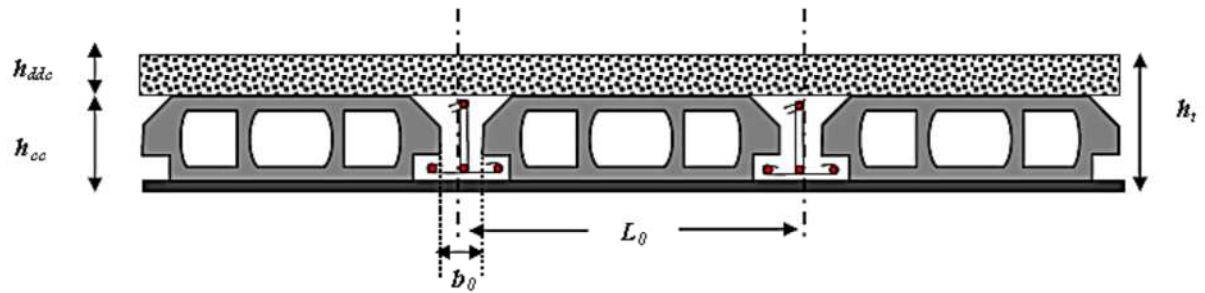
Coupe transversale sur un plancher à corps creux.
